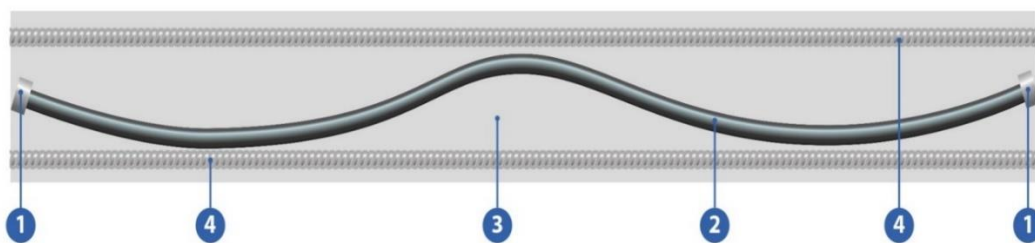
Система предварительного напряжения канатной арматуры без сцепления с бетоном [4]
